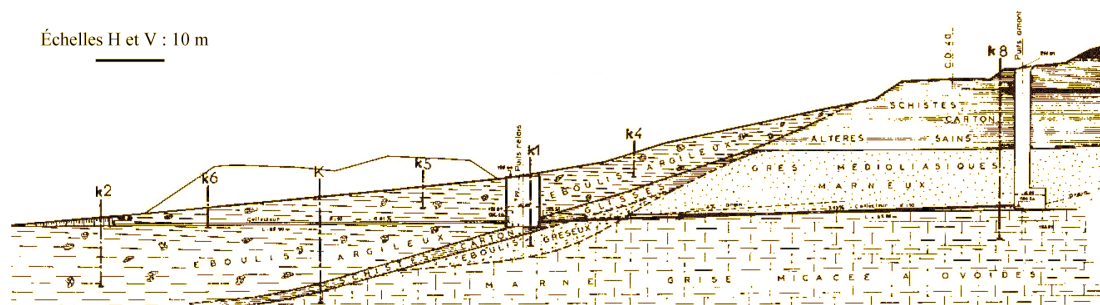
Puits et drains rayonnants (A 31, Château-sous-Clévant)
